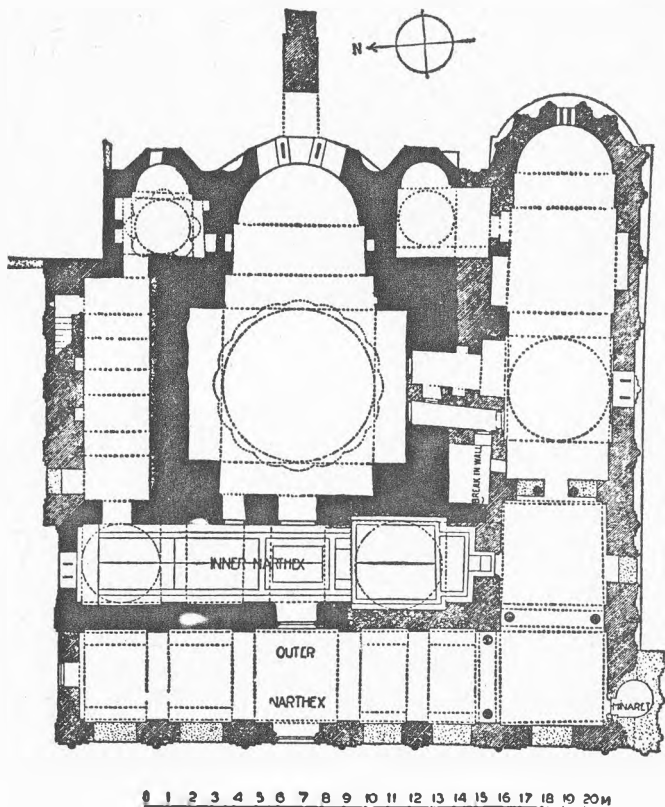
Konstantinopel. Kachrije-Djami (Chorakirche). Grundriß. Kernbau (schwarz) 12. Jh. Äußere Vorhalle und Seitenschiff Anfang 14. Jh.
